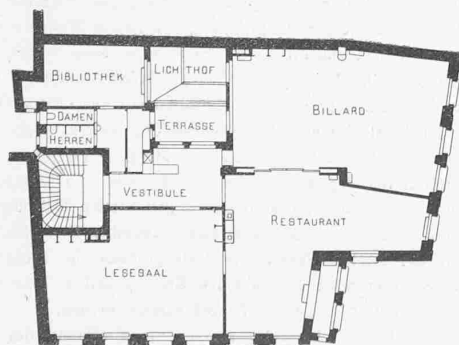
Grundriss vom I. Stock. 1:400.
